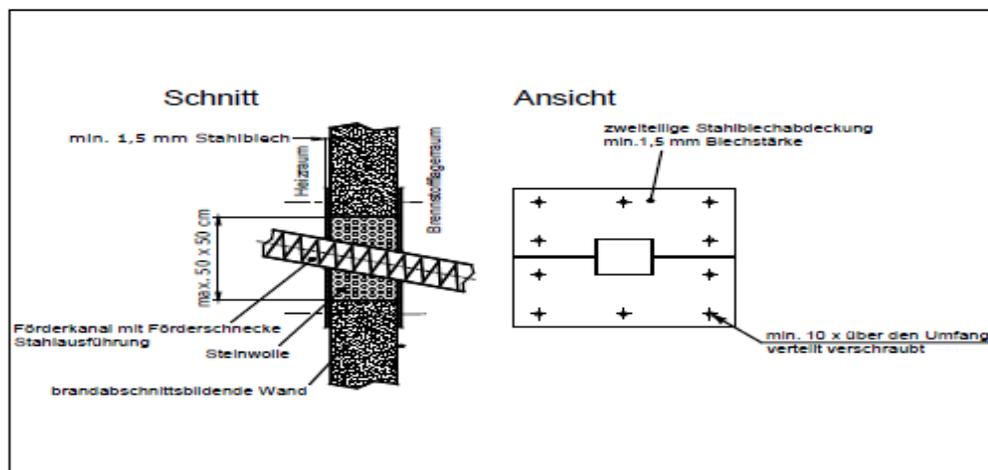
Ausführungsbeispiel einer Förderkanaldurchführung durch eine brandabschnittsbildende Wand zwischen z.B. Heizraum und Brennstofflagerraum.
